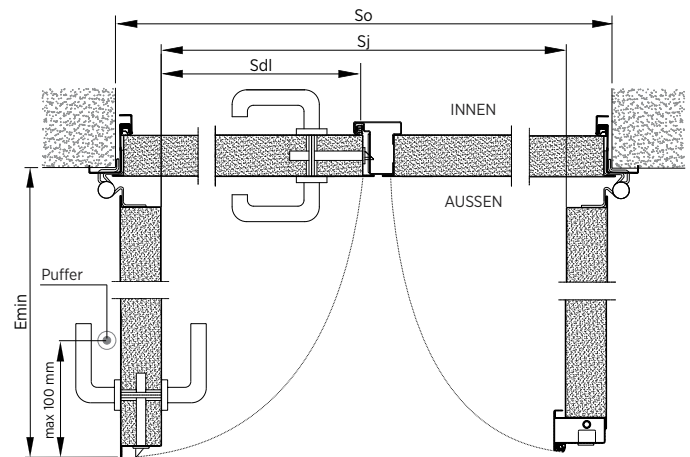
Montage zweiflügeliger Tür vor der Öffnung - Horizontalschnitt
